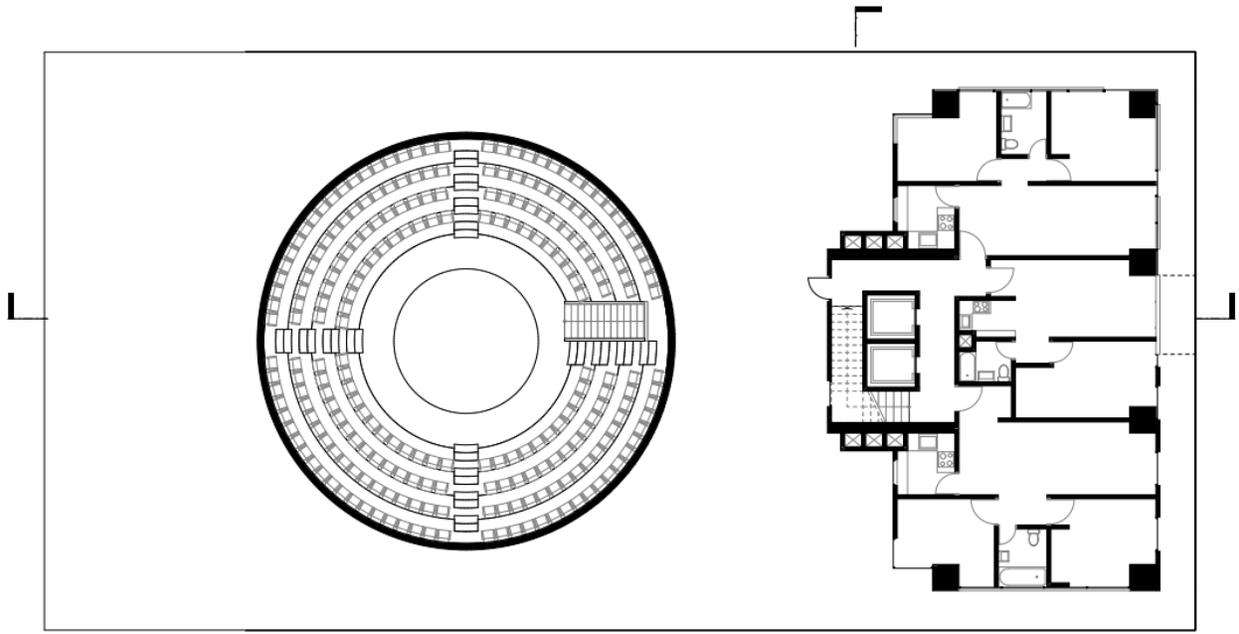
Planta alta actual N+9.50. Fuente: Tesistas.
